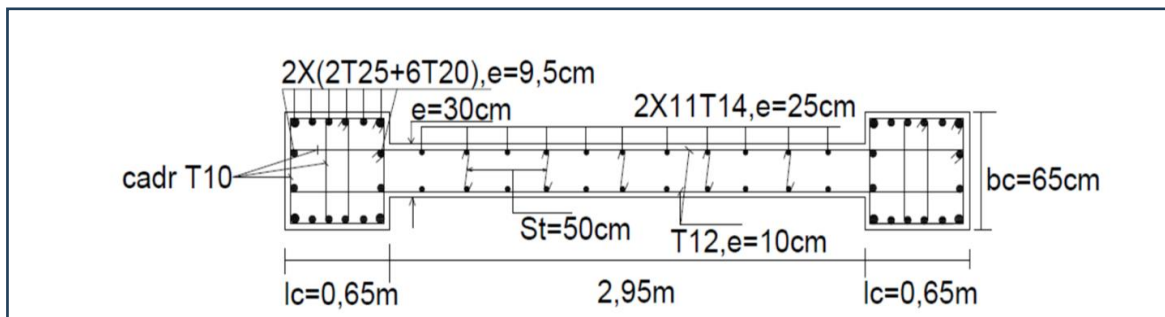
La coupe de ferrailage des voile sens x épaisseur 30cm.
